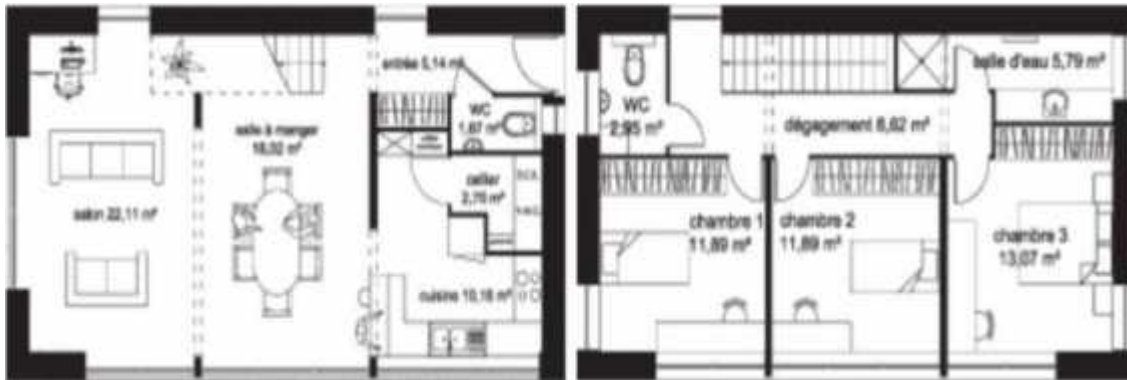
Plan du rez-de-chaussée (à gauche) et de l'étage (à droite) de la maison Chloé
